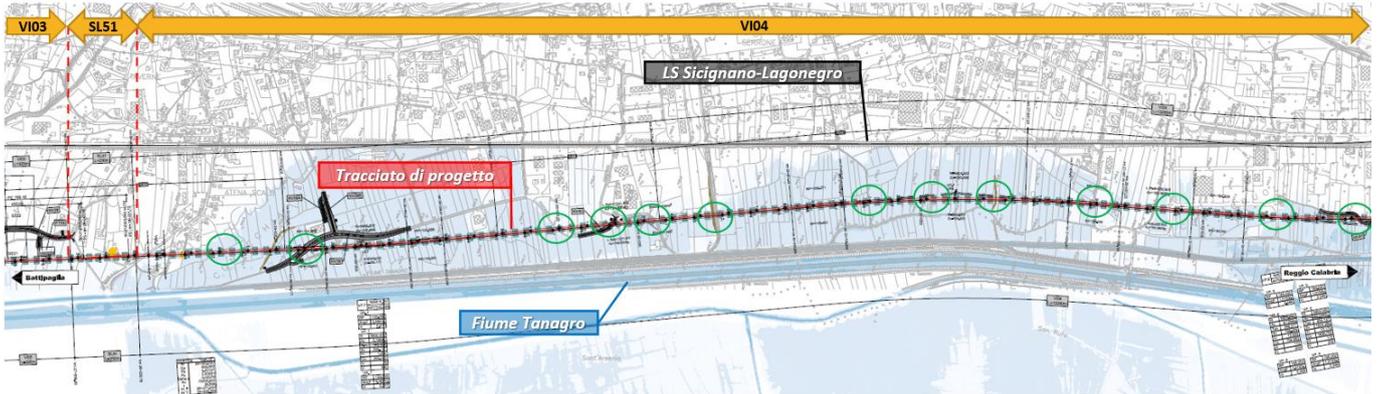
Planopprofilo di progetto da km 39+300 a km 41+486
